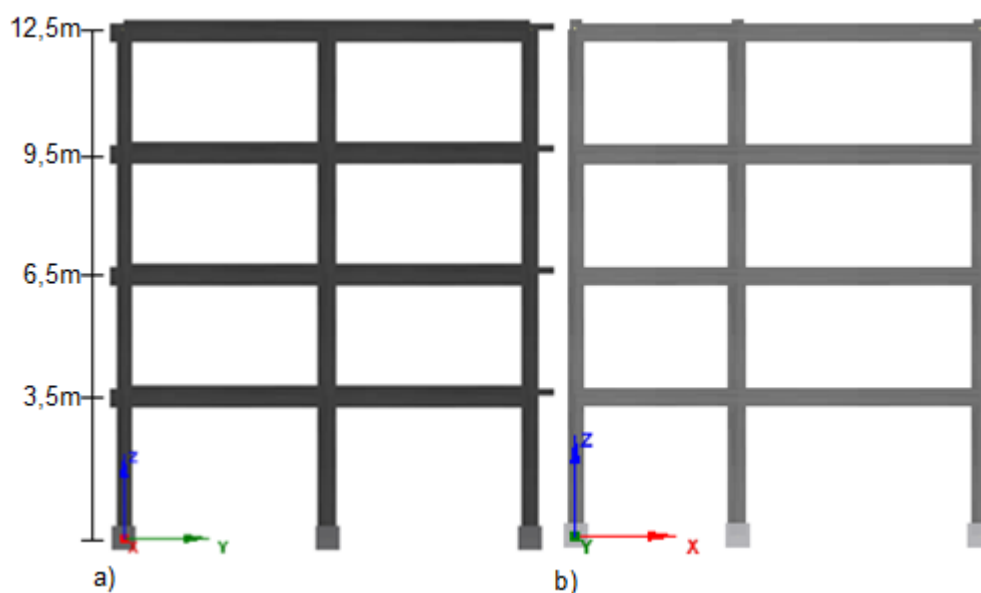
Edifício Elsa Frame – a) Pórtico Longitudinal b) Pórtico transversal
